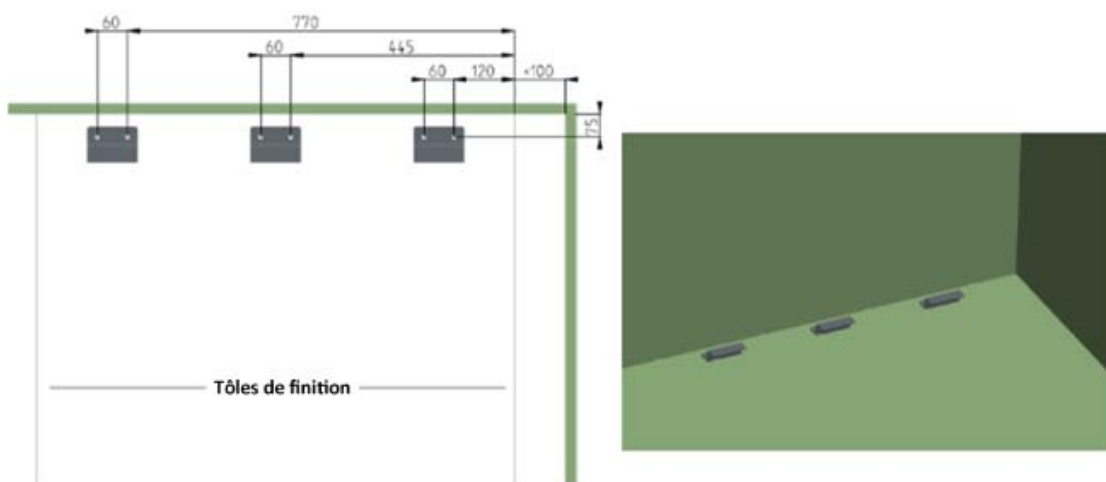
Installation: Installer les colliers de fixation à l'aide d'un socle
